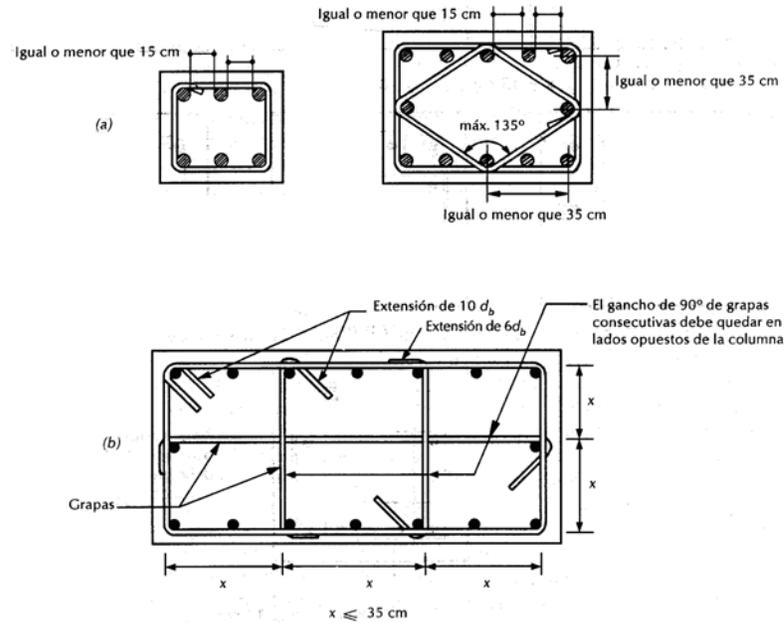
Recomendación estándar para el espaciamiento entre barras longitudinales de una columna.
